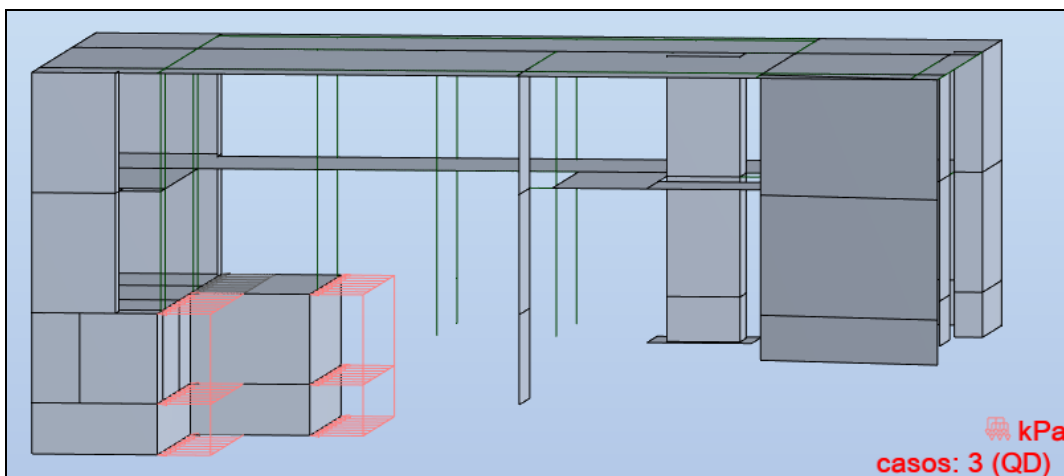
CARGA HORIZONTAL EN EL SUBSUELO
